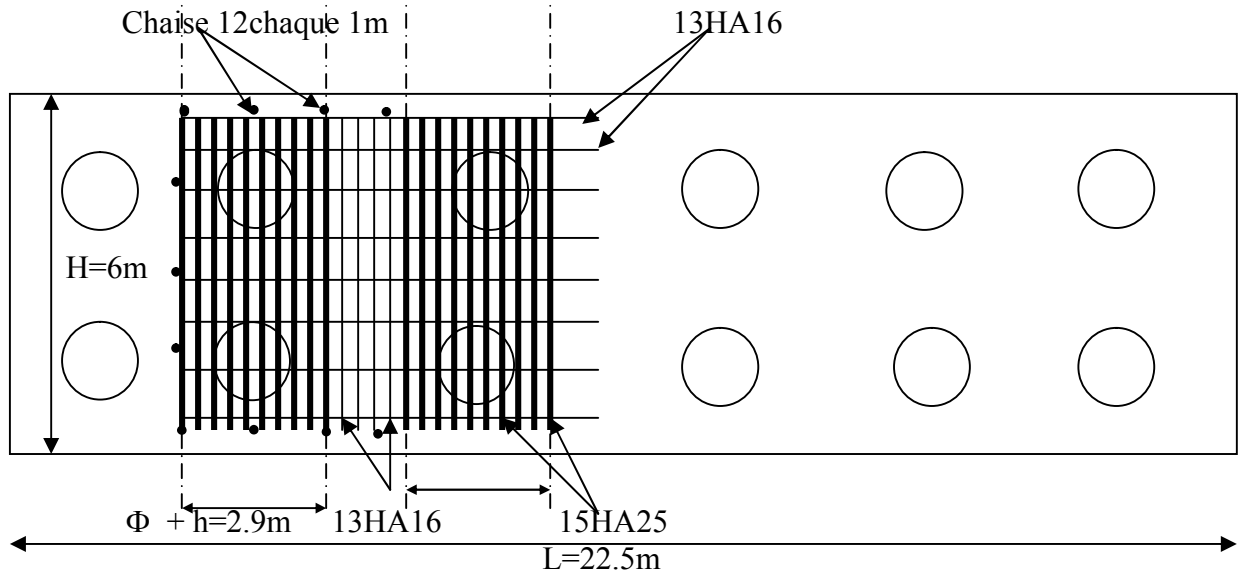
Ferrailage de la semelle (nappe inférieure)
